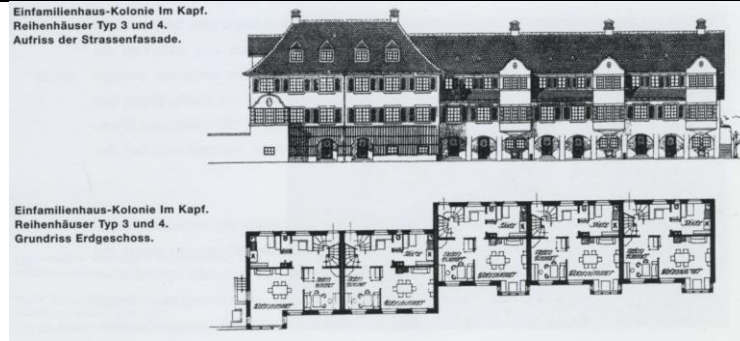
Zwei Typen Reihenhäuser, Aufriss und Grundriss (aus von Burg, S. 119)
